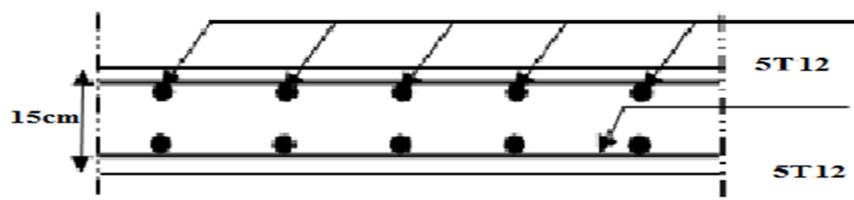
Coupe horizontale du ferrailage du voile.
